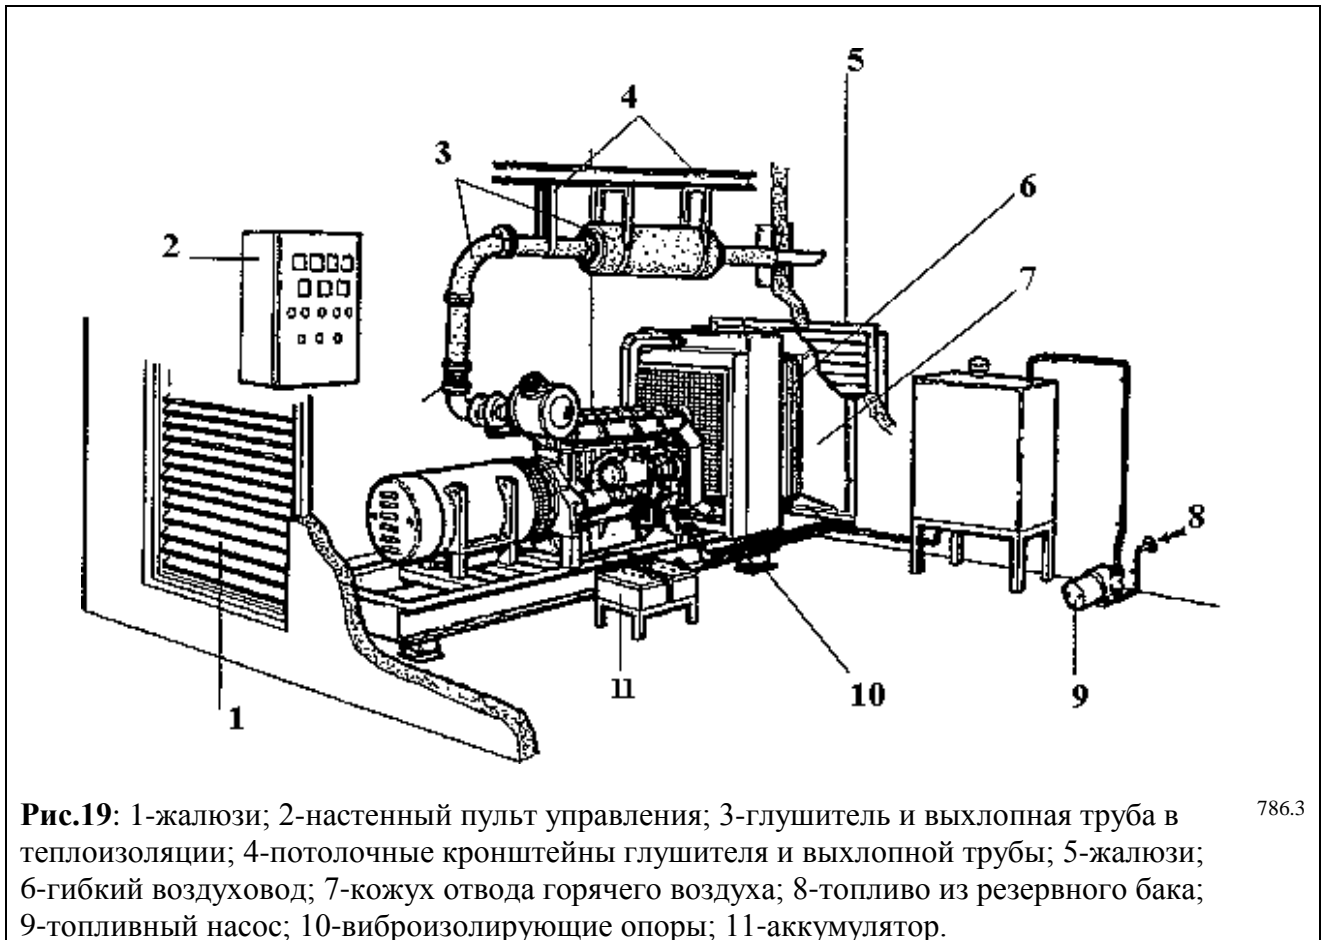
1-жалюзи; 2-настенный пульт управления; 3-глушитель и выхлопная труба в теплоизоляции; 4-потолочные кронштейны глушителя и выхлопной трубы; 5-жалюзи; 6-гибкий воздуховод; 7-кожух отвода горячего воздуха; 8-топливо из резервного бака; 9-топливный насос; 10-виброизолирующие опоры; 11-аккумулятор.
